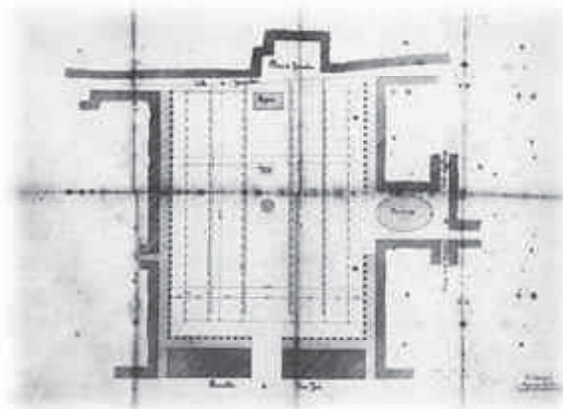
, Planta Arquitectónica Mercado La Boqueria
